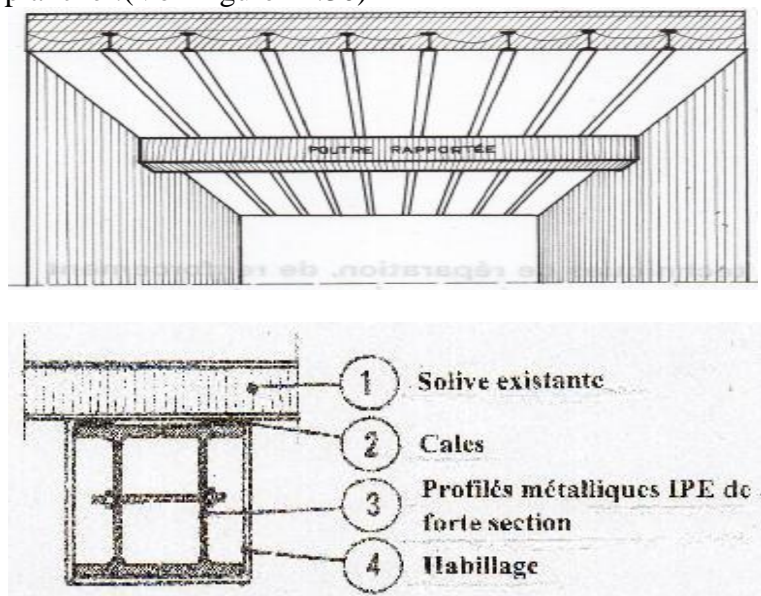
Renforcement d'un plancher métallique par recouplement d'une travure Par une poutre métallique
